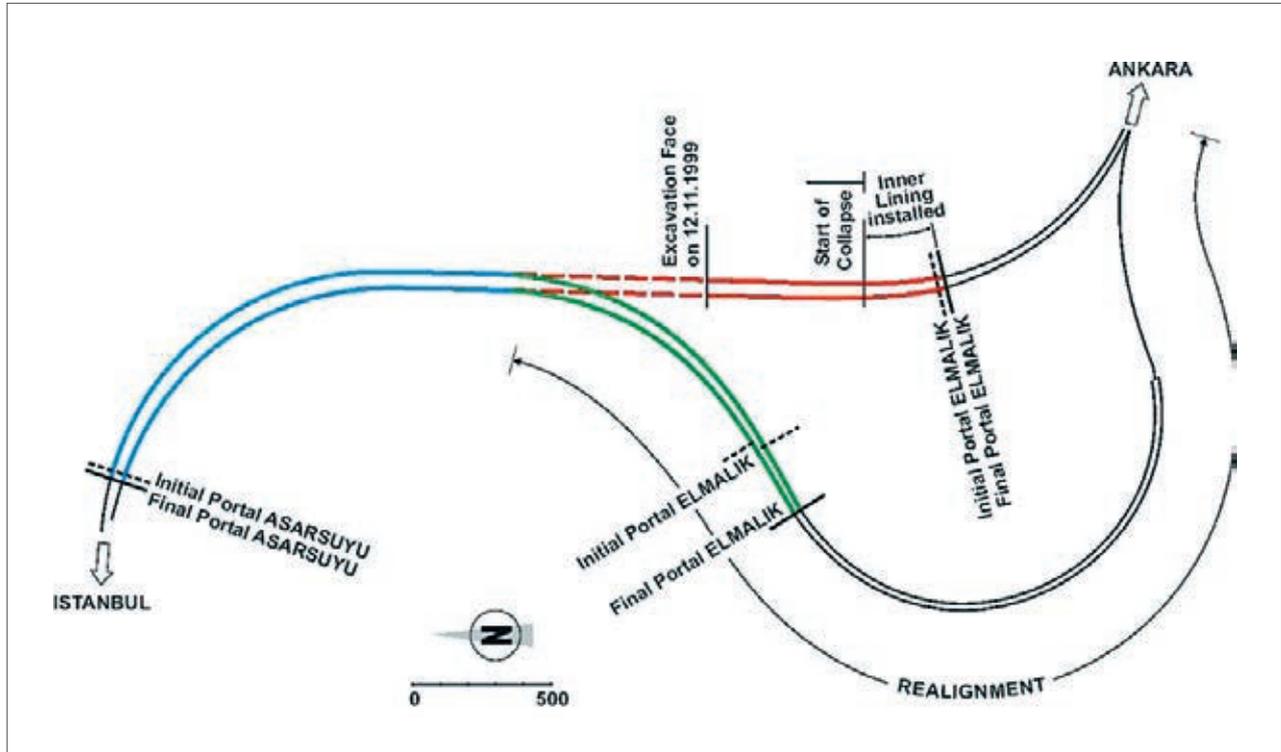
Trassenänderung des Bolu Tunnels | Fig. 6. Realignment of Bolu
